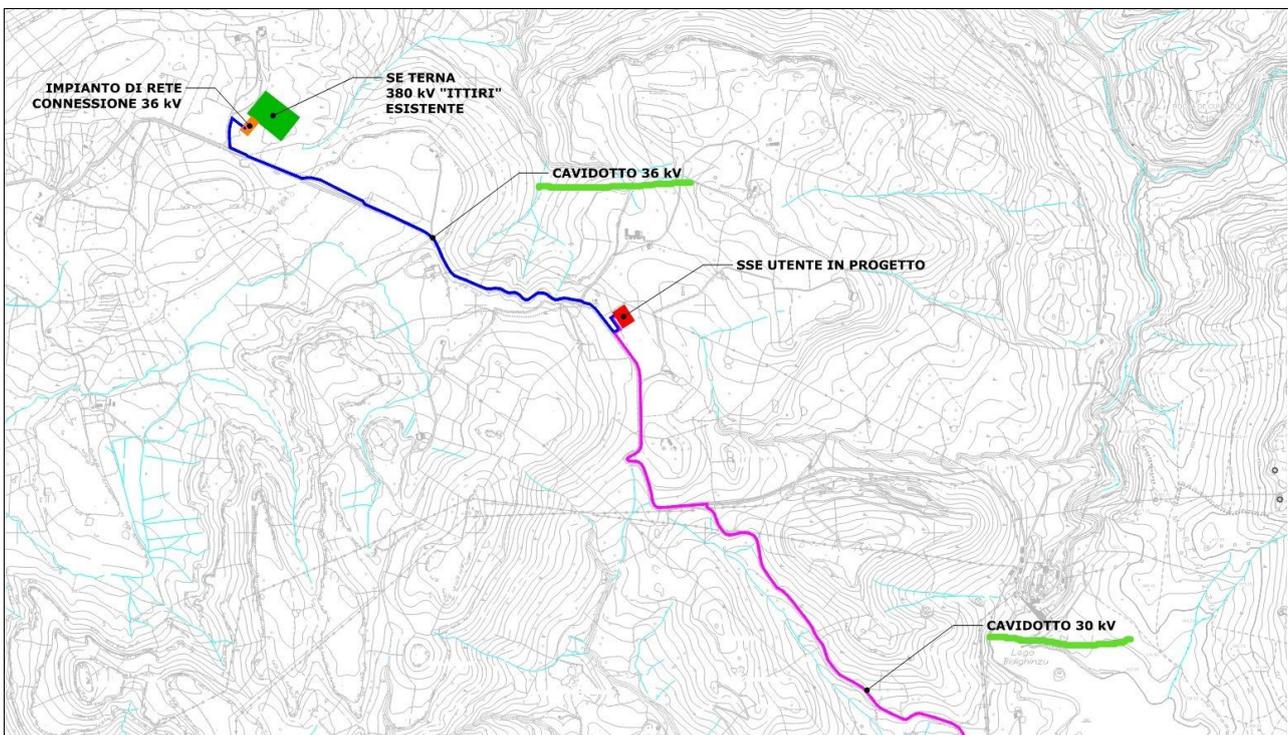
Ubicazione sottostazione elettrica e cavidotto in progetto (planimetria fuori scala)
